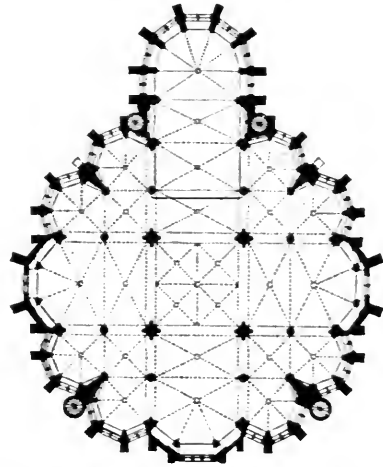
Grundriß der Liebfrauenkirche zu Trier.
